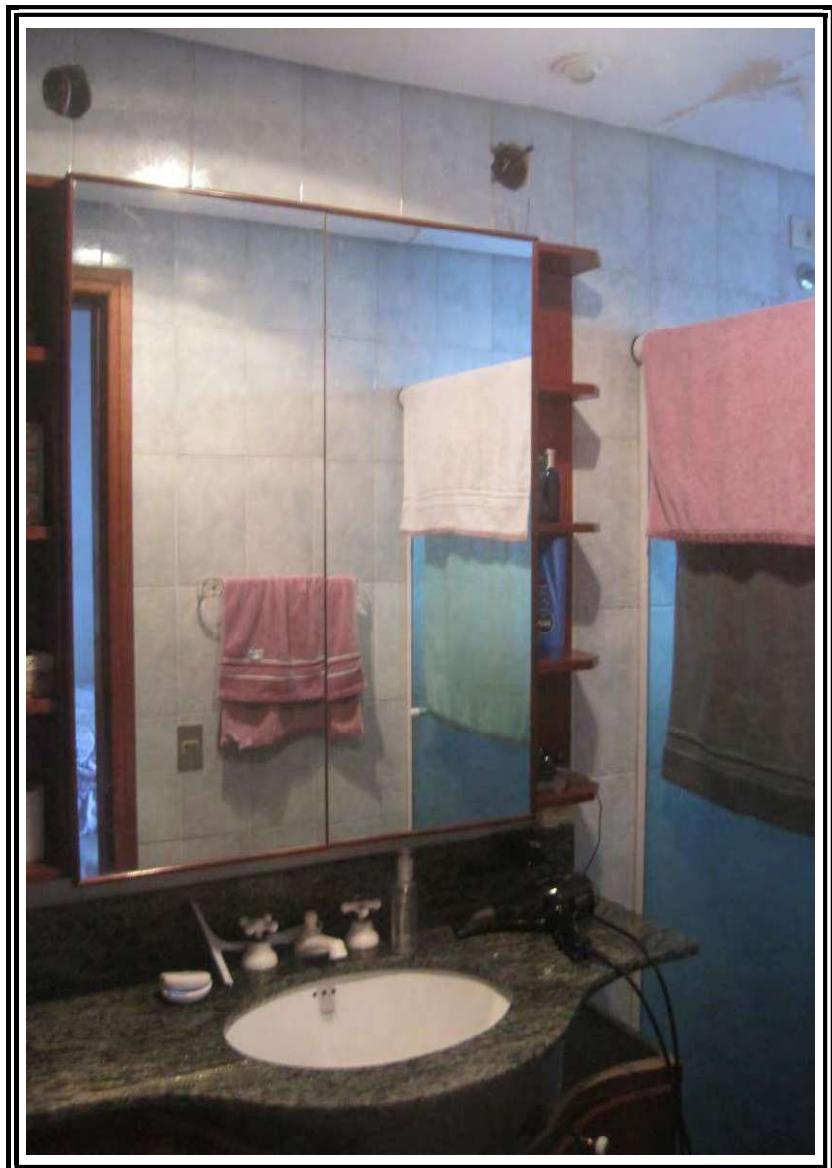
Vista do banheiro do dormitório 03 (suíte)
